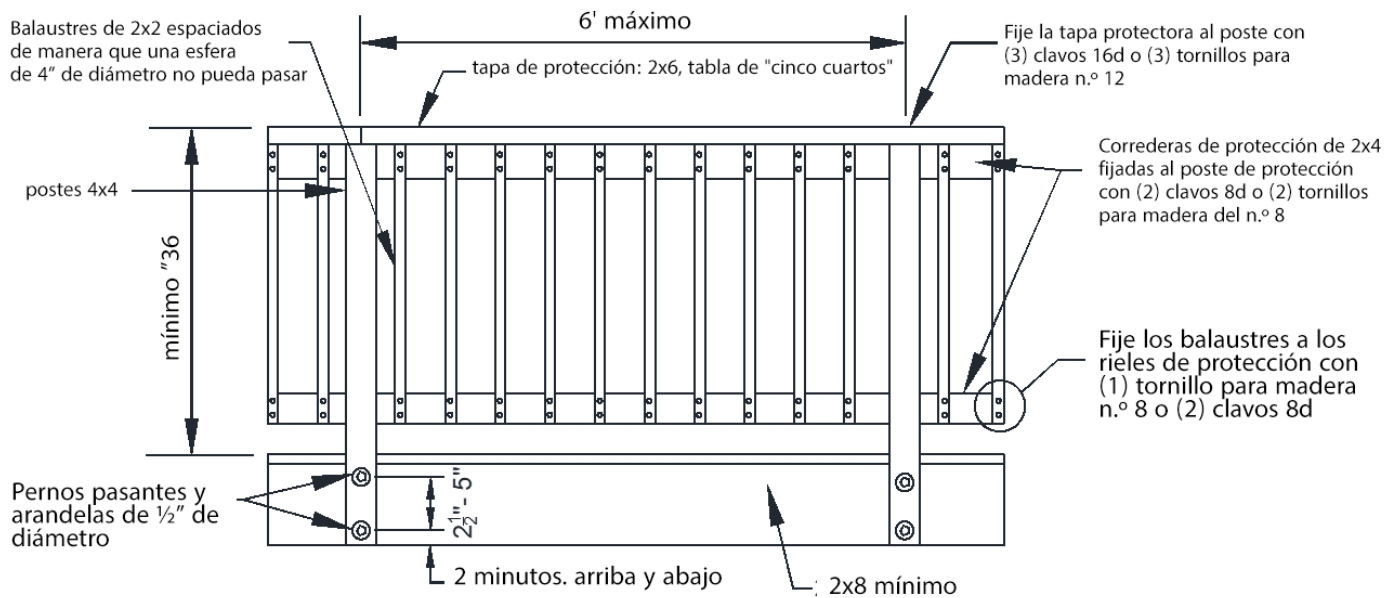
CONSTRUCCIÓN DE PROTECCIÓN
